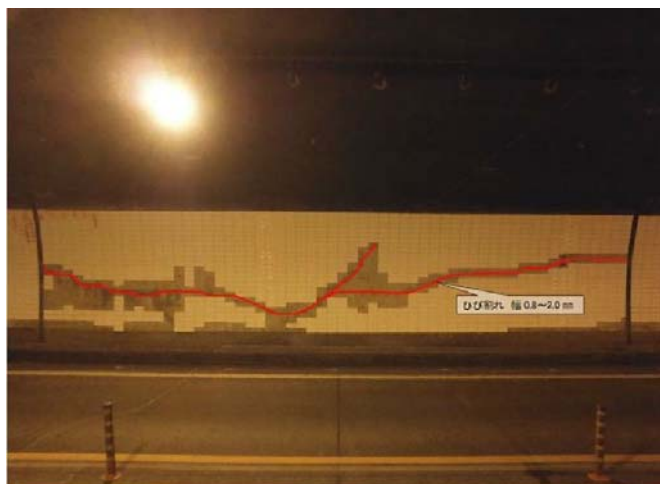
トンネルに生じたひび割れ状況¹⁾
